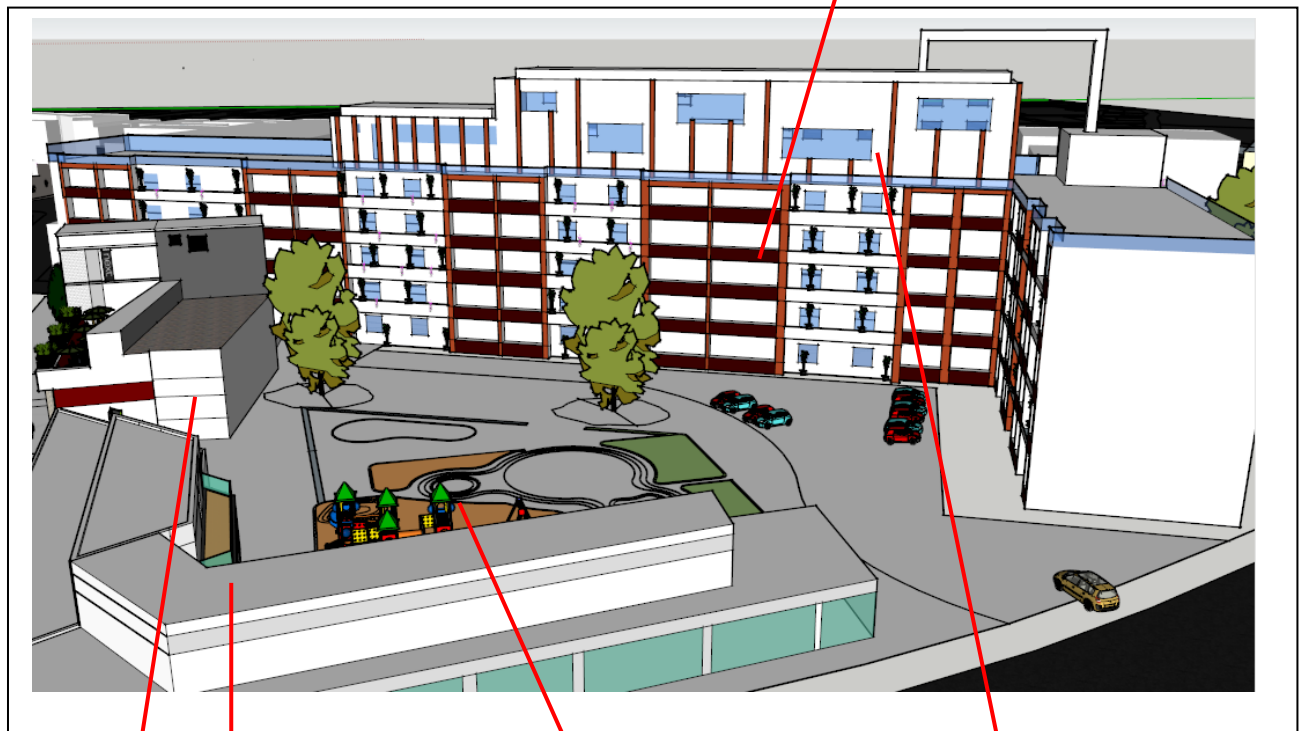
Vue sur 3D proposition, façade Sud du bâtiment. Source Auteurs
